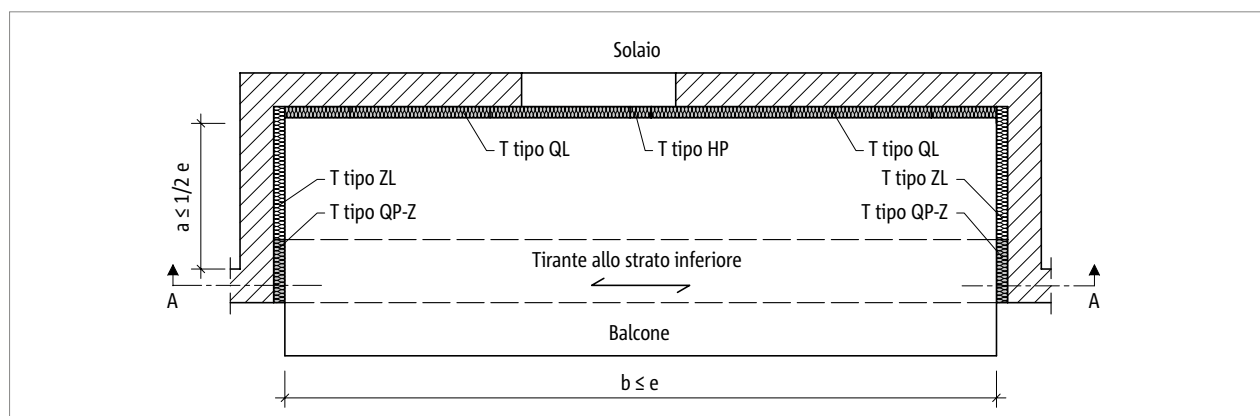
Schöck Isokorb® T tipo QP-Z, QL: pianta loggia
